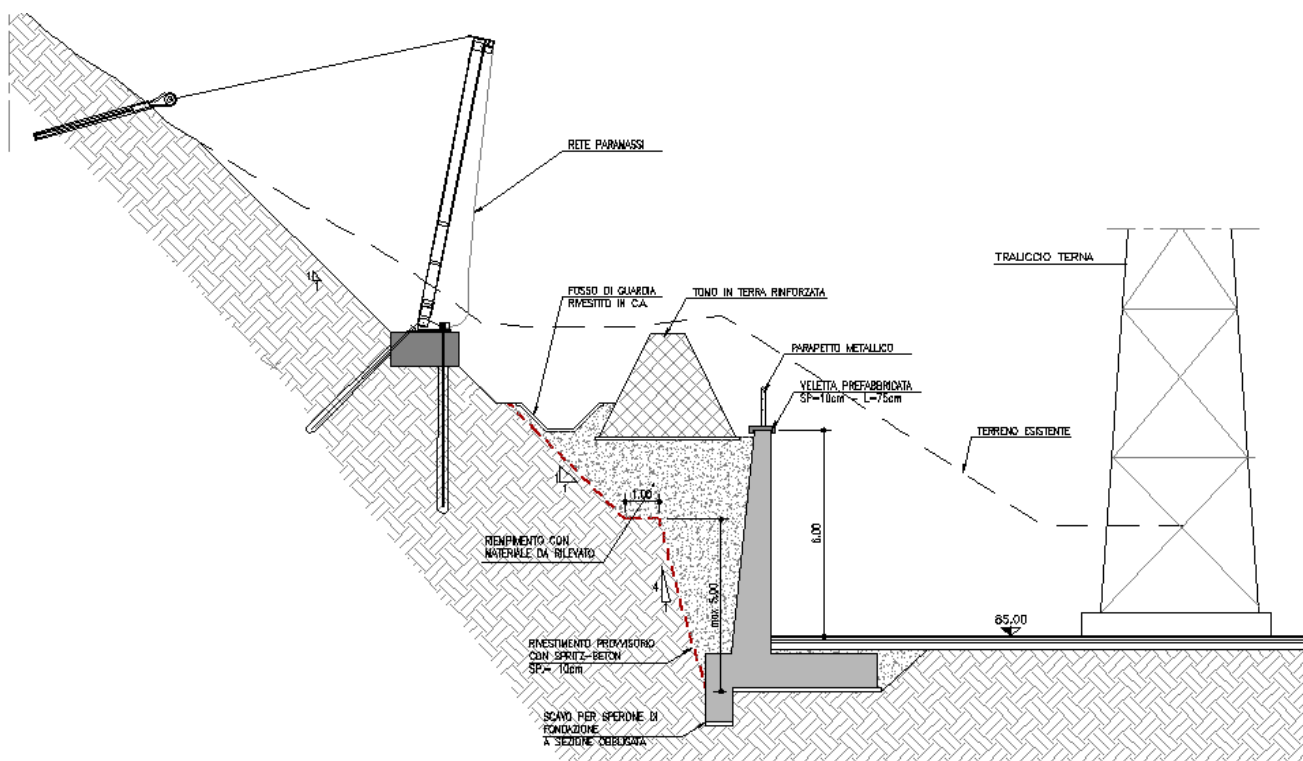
Muro di controripa MC01 – Sezione tipo
